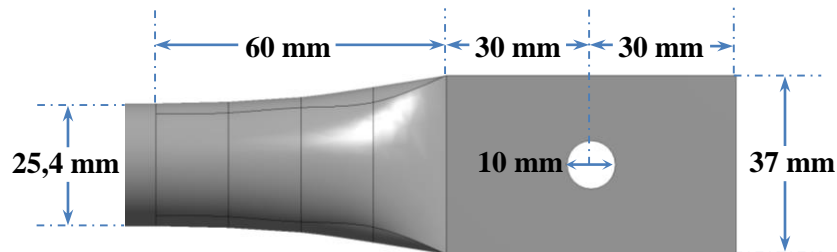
Detalhe da ponta do banzo (Planta)
